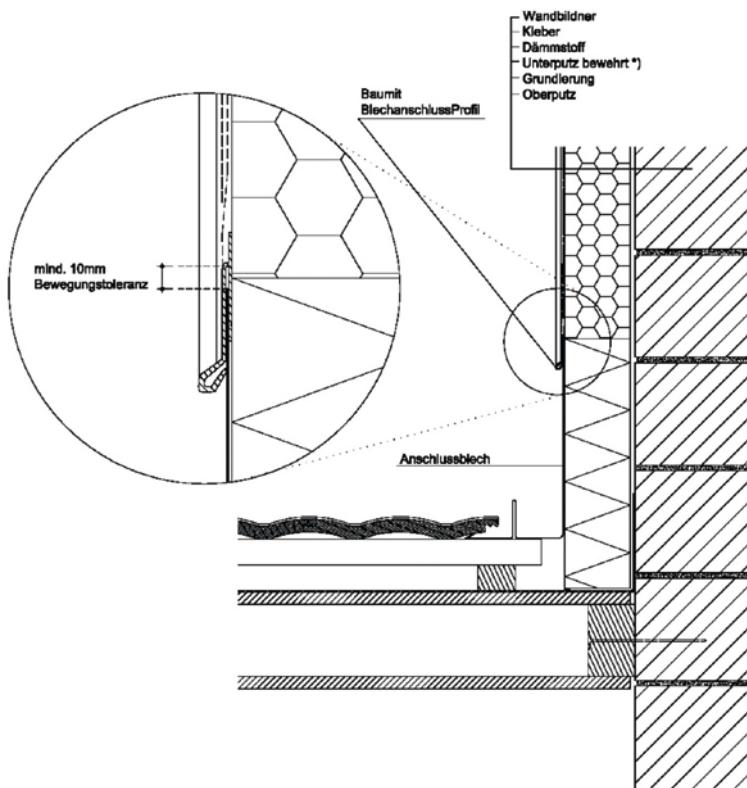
Detail des wärmebrückenfreien Blechanschlusses [Baumit Baustoffe GmbH]
